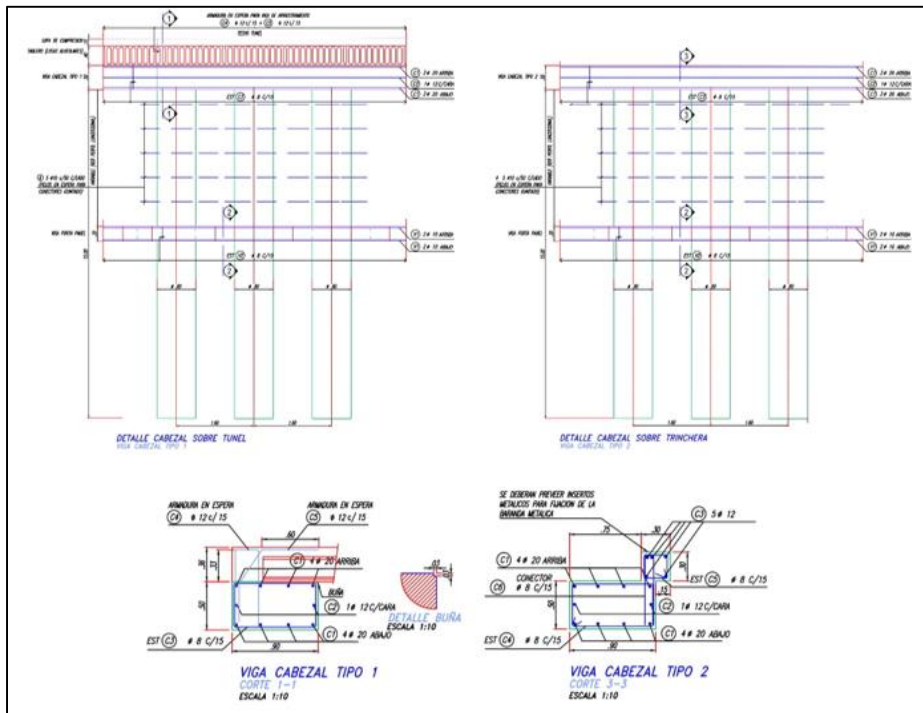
Perfil longitudinal y sección transversal de la viga cabezal. (PLANO N° 27)
